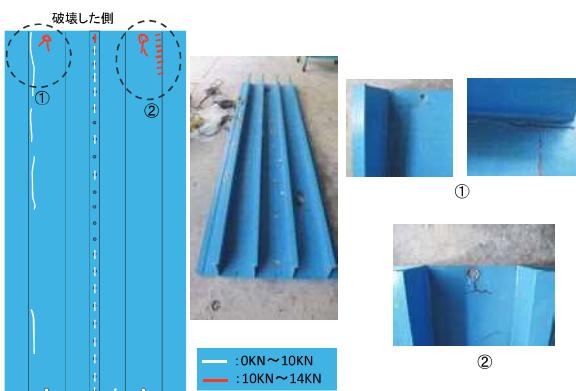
ひび割れ及び破壊状況図（スタッドタイプ）
